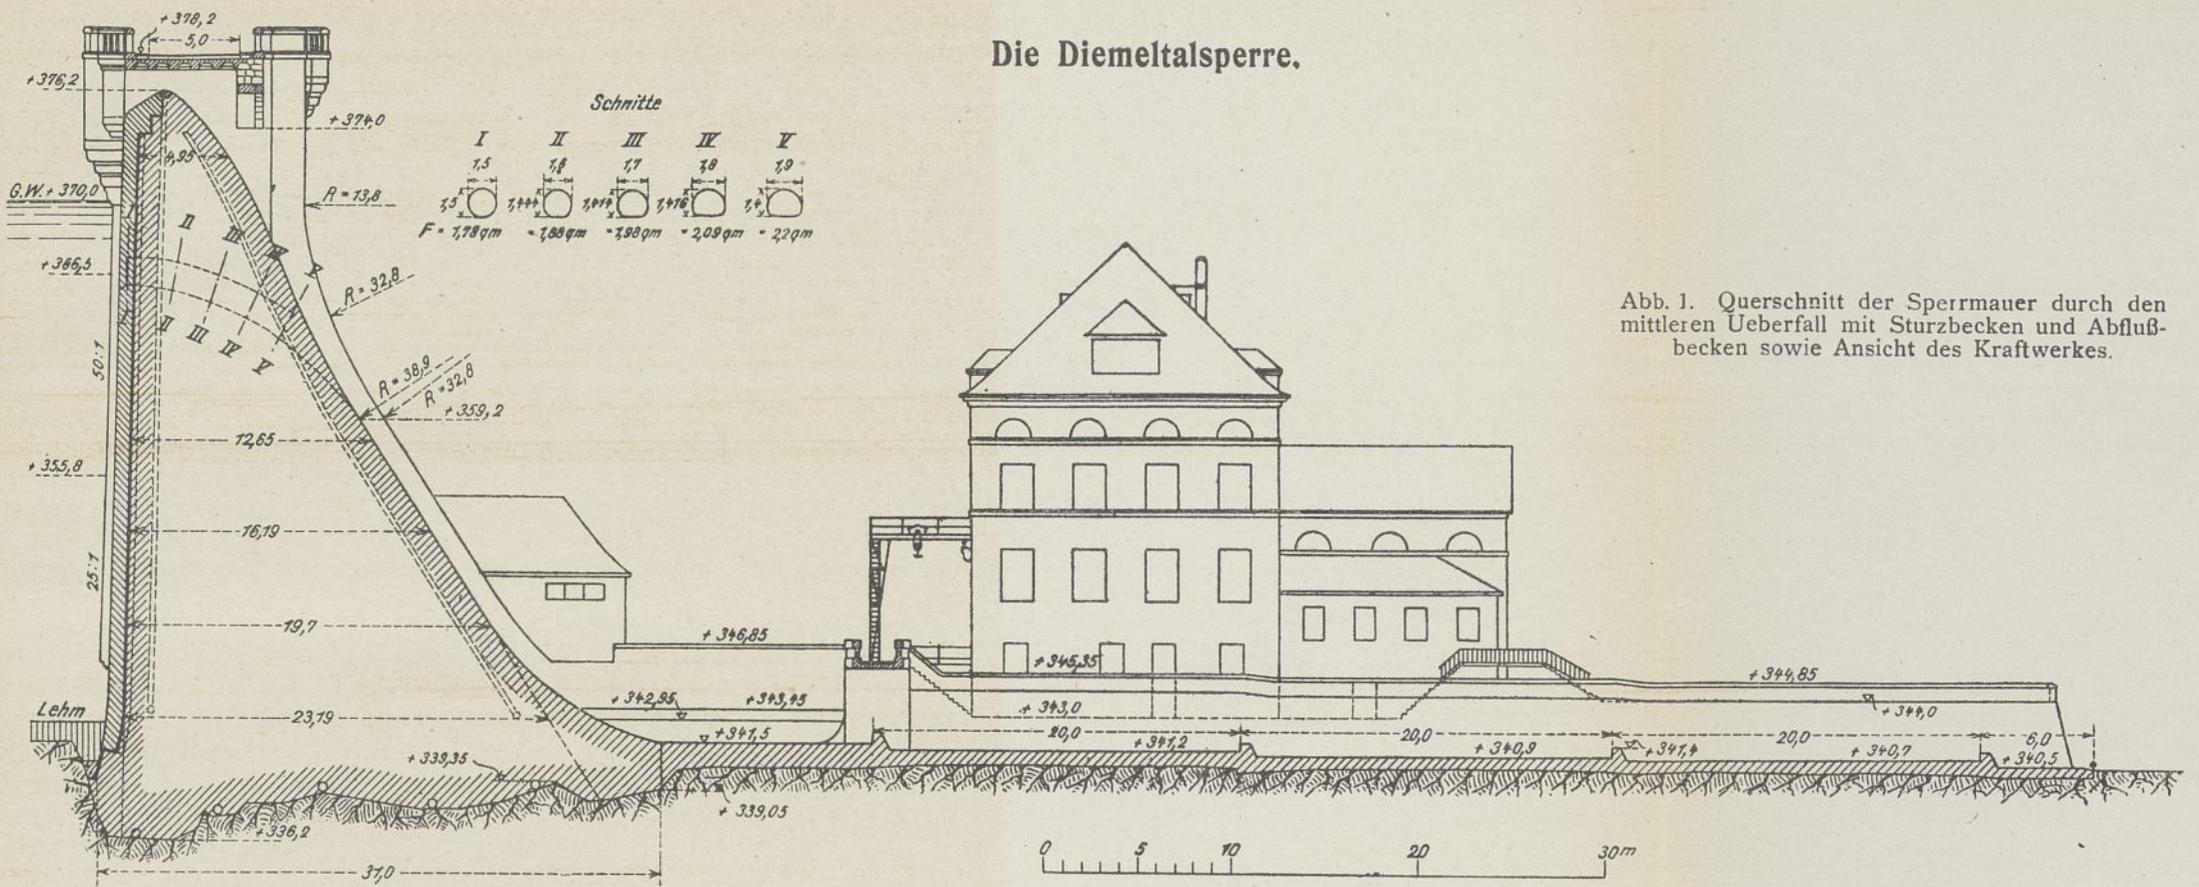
Querschnitt der Sperrmauer durch den mittleren Ueberfall mit Sturzbecken und Abflußbecken sowie Ansicht des Kraftwerkes.
